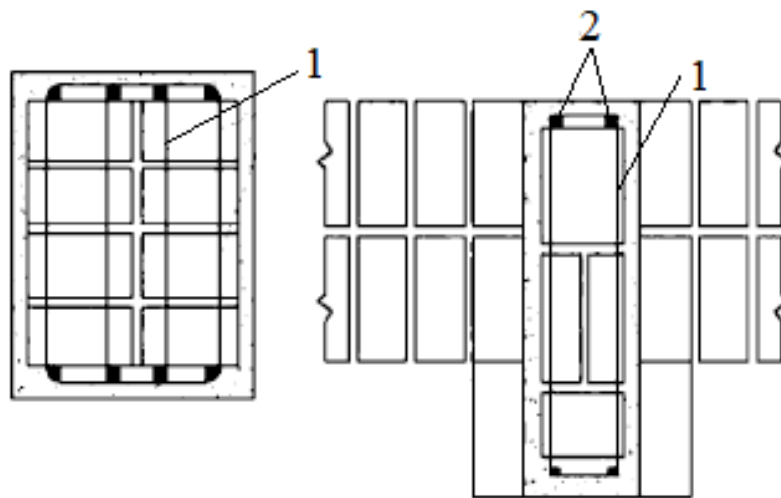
Схеми поздовжнього армування кладки:
